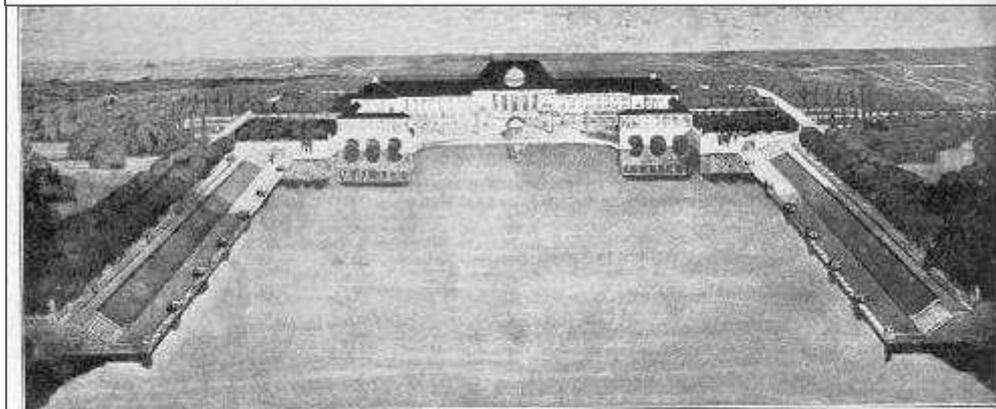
Stadtpark Hamburg. Hauptrestaurant mit Terrassen.
